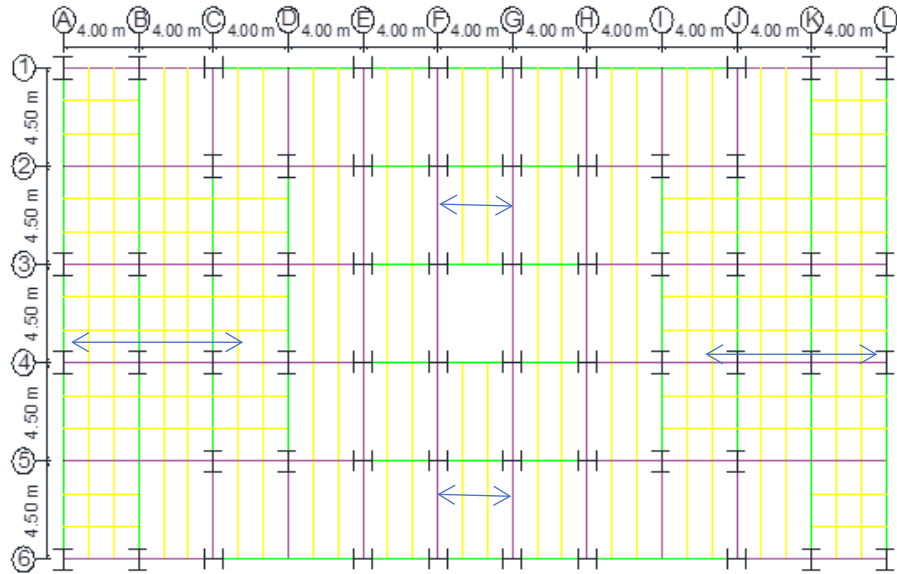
Planta del entrespado de la edificación con panel Vierendeel 1m.
